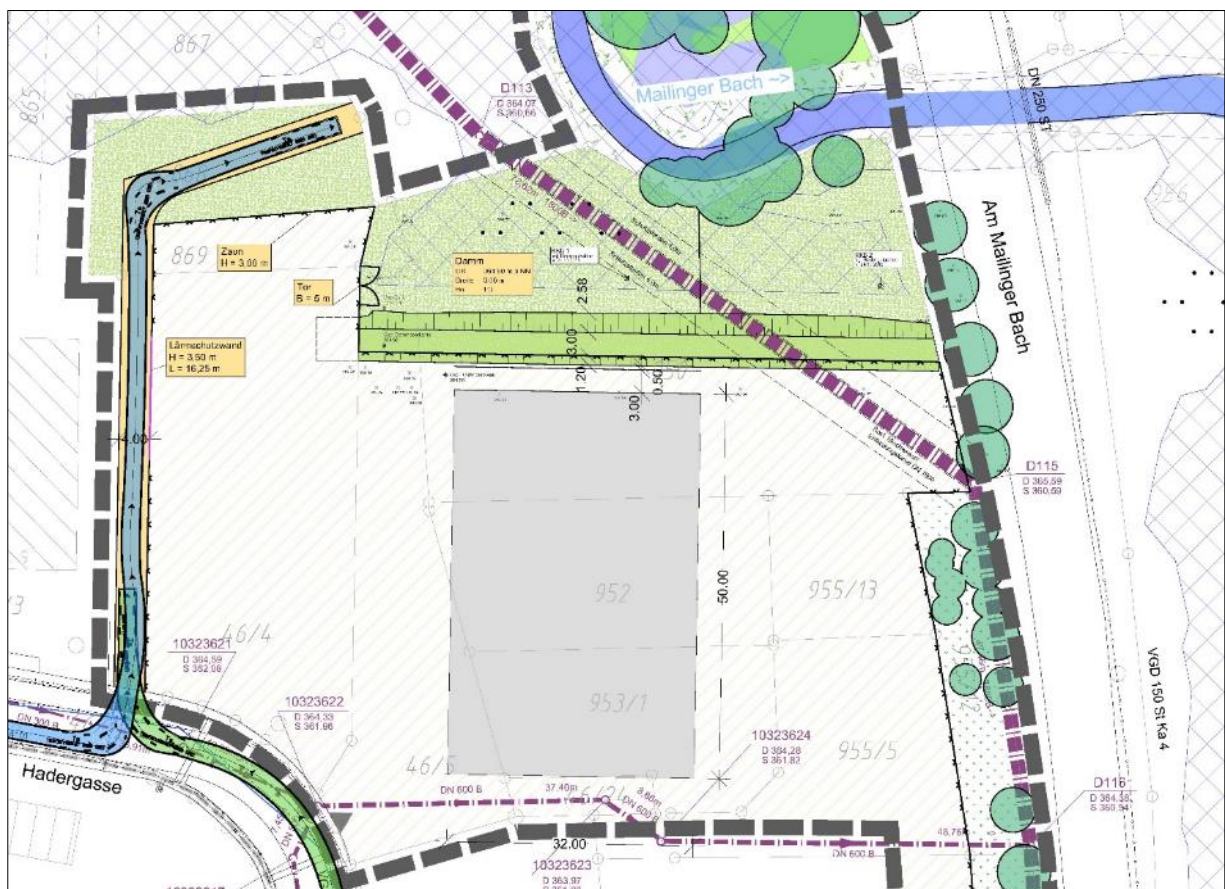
Lage der geplanten Halle (Lageplan WipflerPLAN 15.02.2021)
